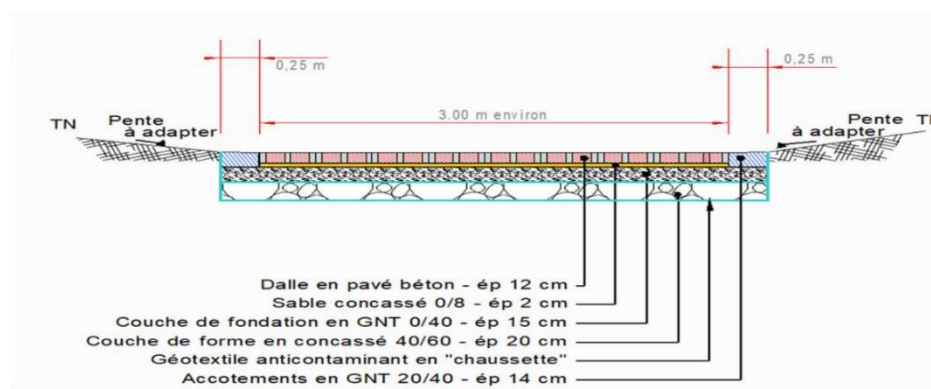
coupe de la structure de fondation d'une chaussée en dalle gazon (Andrieux, 2024)
